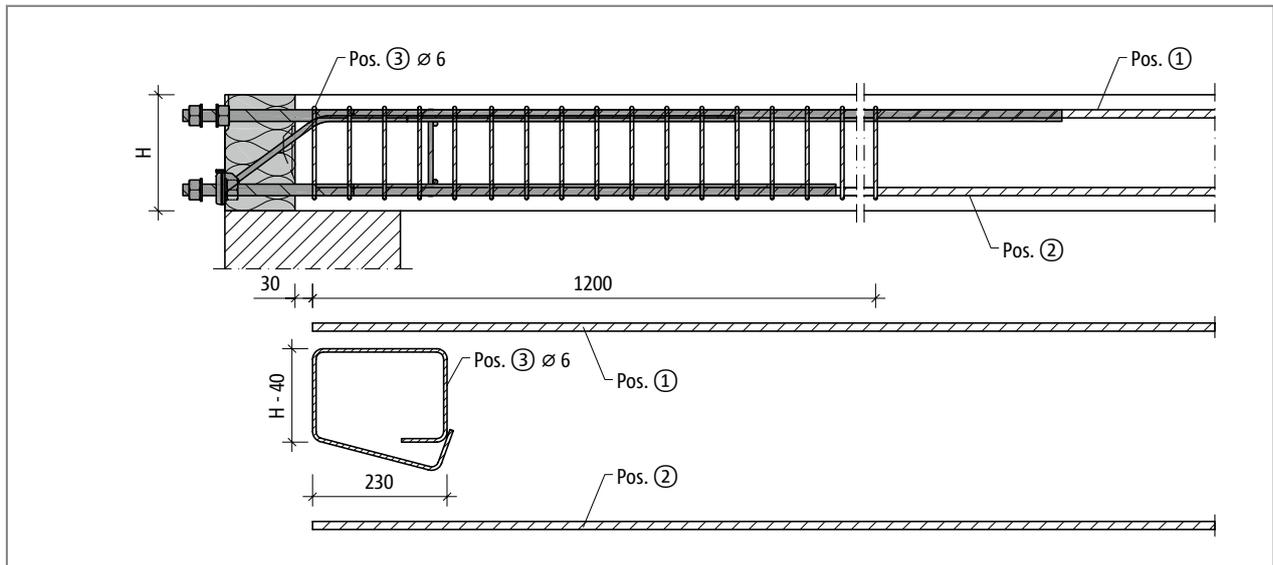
Schöck Isokorb® XT Typ SK-MM2: Bauseitige Bewehrung mit Bügel  $\varnothing 6$  mm; Schnitt
